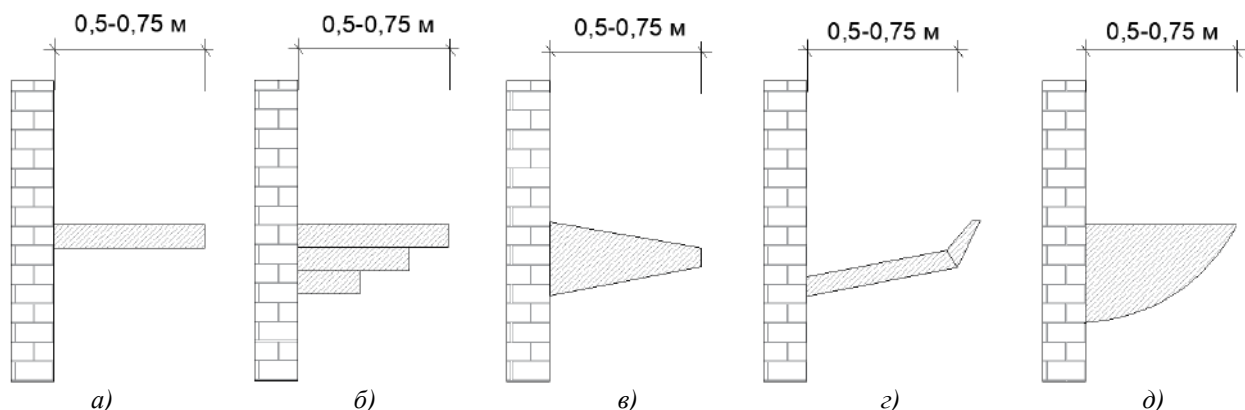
Зовнішній вигляд протипожежних карнизів: де а) – стандартний протипожежний карниз прямої форми; б) – протипожежний карниз трикутної форми; в) – протипожежний карниз у формі трапеції; г) – протипожежний карниз у формі «вінглету» д) – протипожежний карниз обтічної форми півкола
